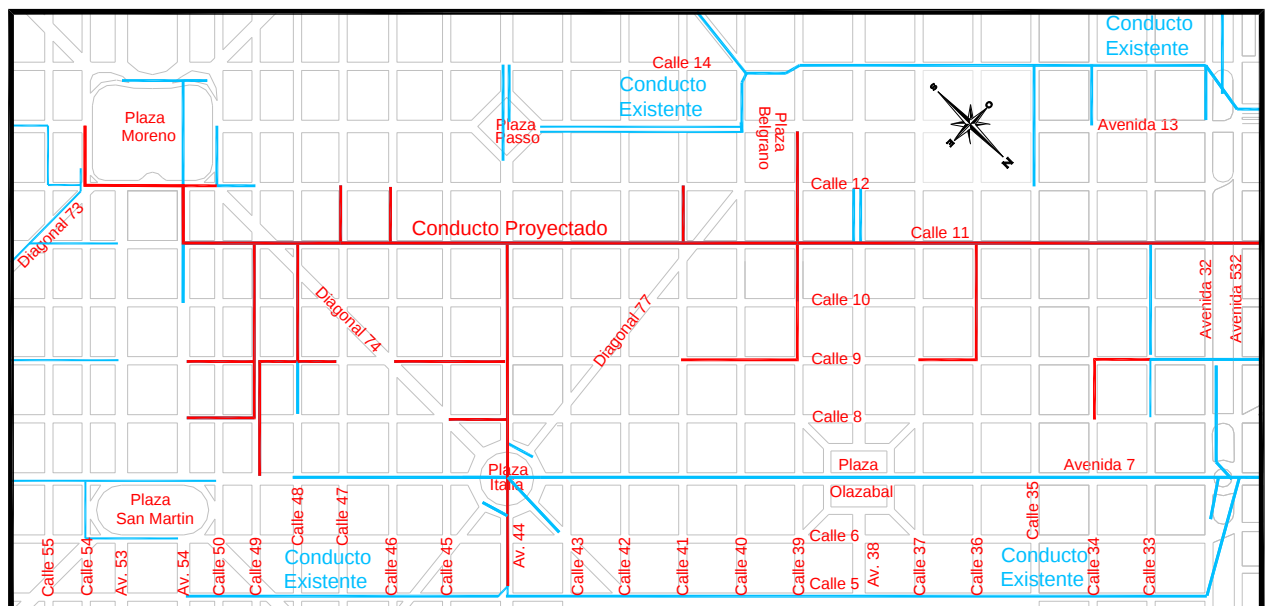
Detalle de la traza del conducto hasta la calle 32.
